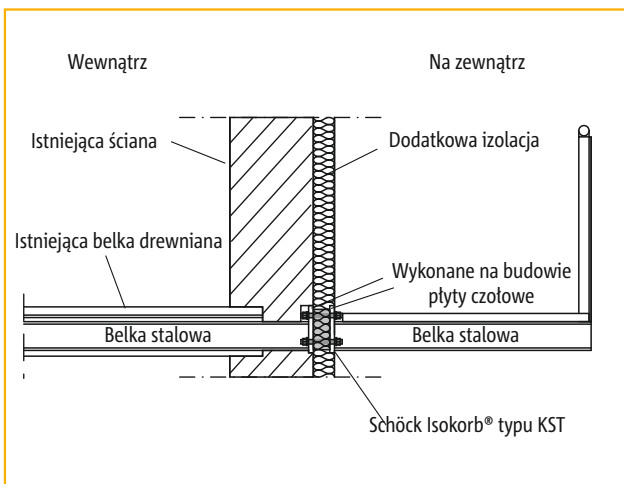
Schöck Isokorb® typu KST w prześle
